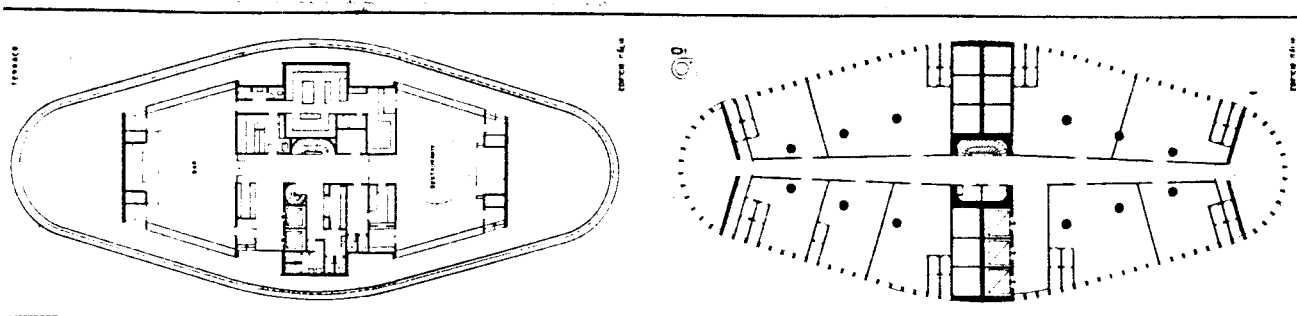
PLANTA DO TERRAÇO E DO ANDAR TIPO DO EDIFÍCIO ITÁLIA
